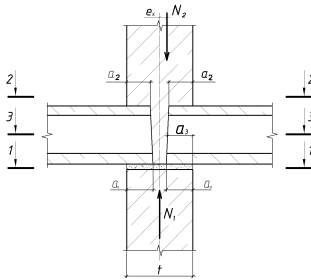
Комбинированный горизонтальный стык стен из монолитного железобетона
